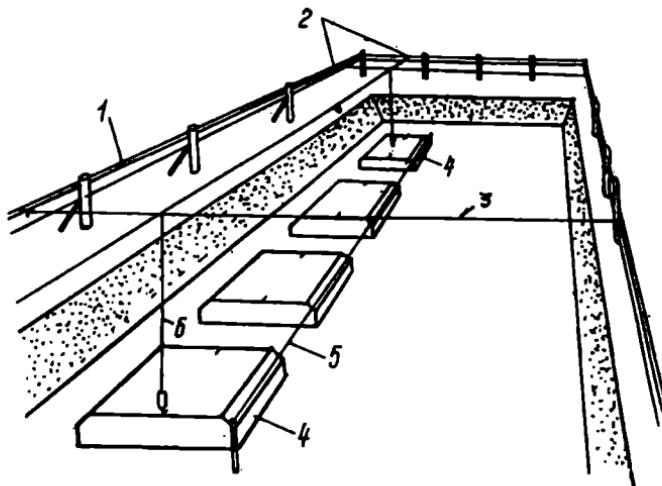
Схема перенесения разбивочных осей в котлован отвесами:
